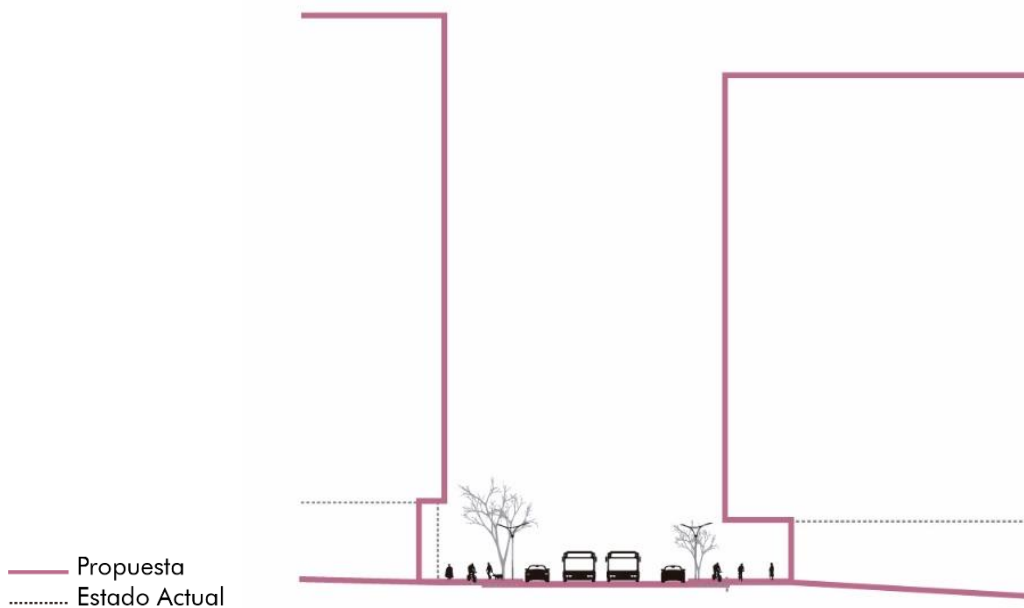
Corte transversal en av. Galo Plaza Lasso, situación actual y proyectada. (Elaborado por: Jaire Cagigal)
